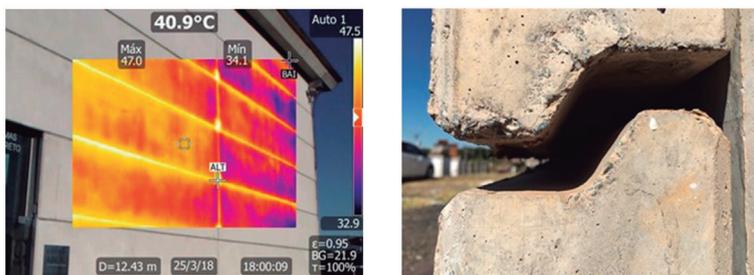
a) Termovisor com medida externa na fachada oeste do laboratório NETPRE; b) Foto da junta horizontal entre painéis de fachada no laboratório NETPRE.
